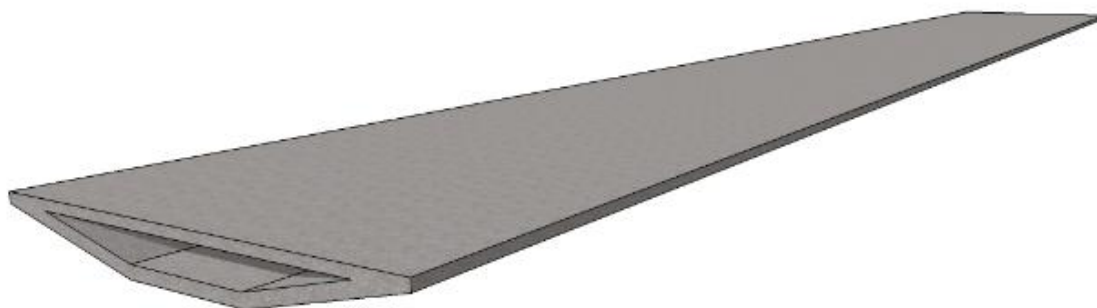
Pormenor do pavimento da ponte de Eindhoven com 0.4m de altura (FDN-Engineering)
